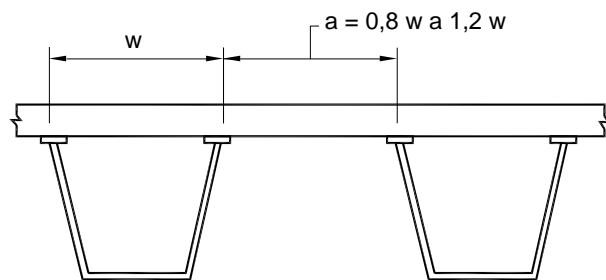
Distancia entre los centros de las alas
